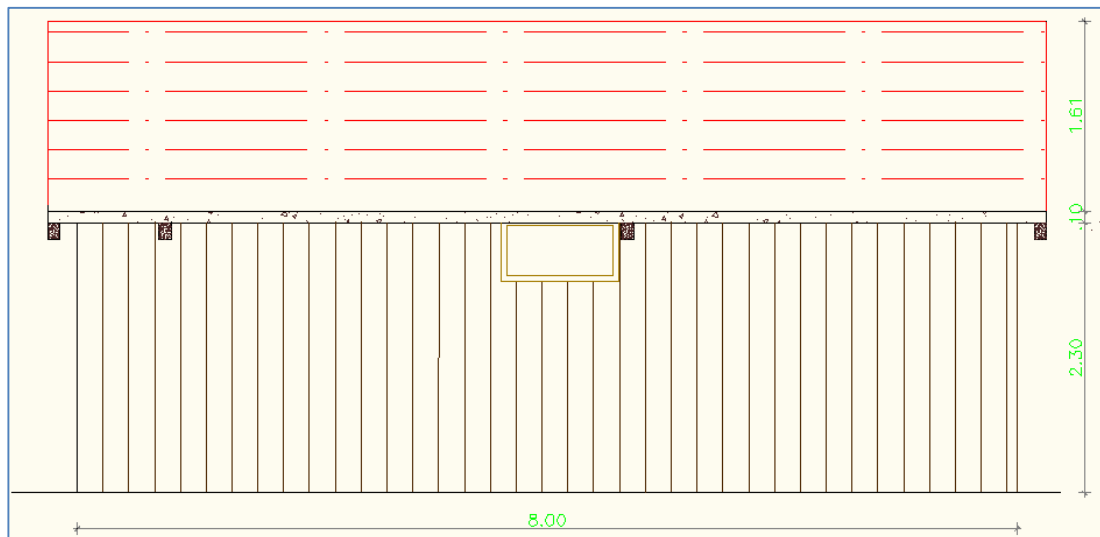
FACHADA LATERAL VIVIENDA EN MADERA
